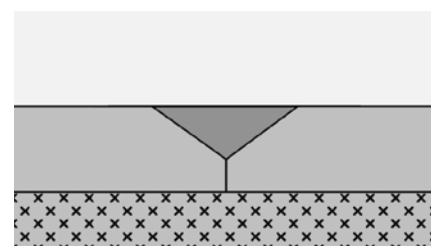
Большая площадь контакта сварочного шнура и покрытия. При этом прочность сваренного шнура примерно 140 N/см.
